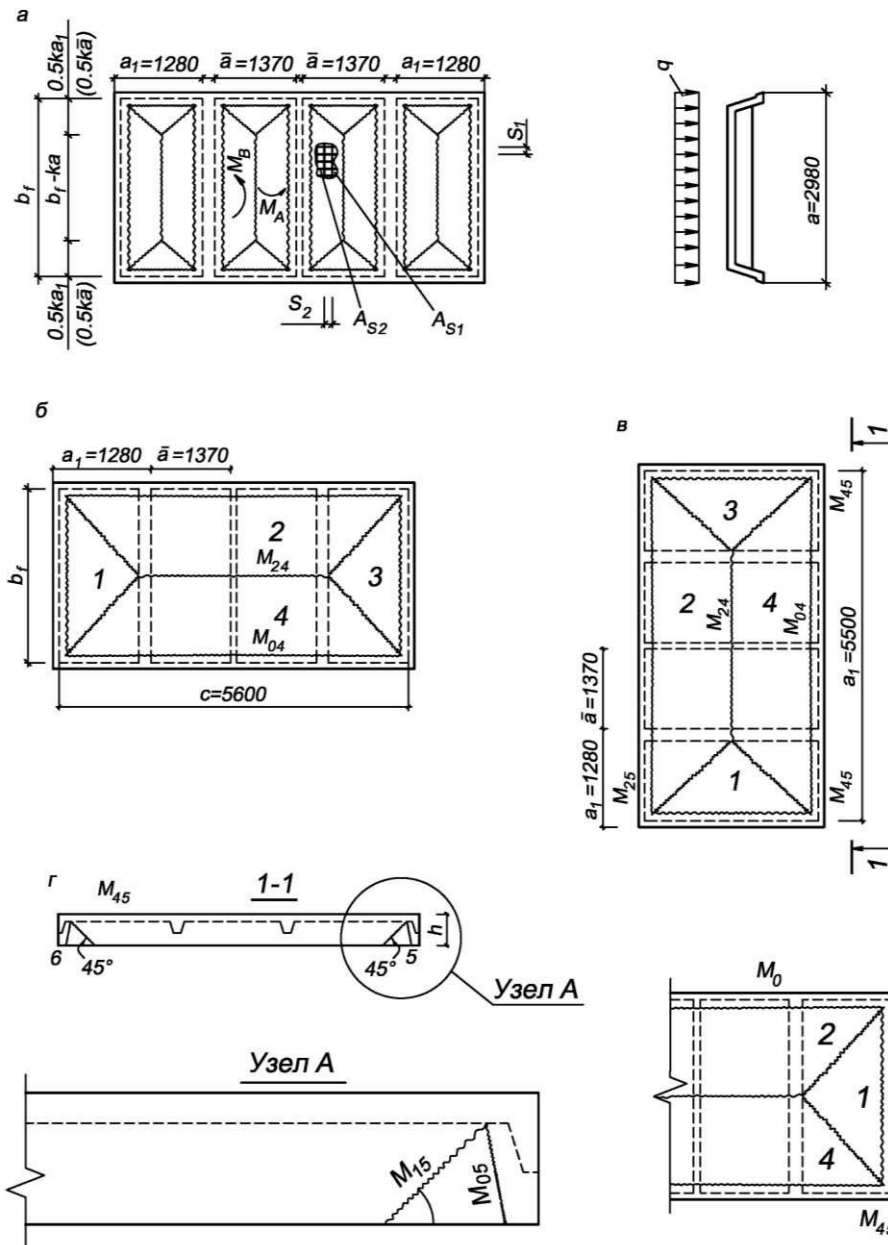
Схемы разрушения полки и поперечных ребер плит от изгиба и продольных ребер от кручения: а, б - для всех плит; в, г - то же, для крайних плит; 1... 5 - жесткие звенья в схемах разрушения
